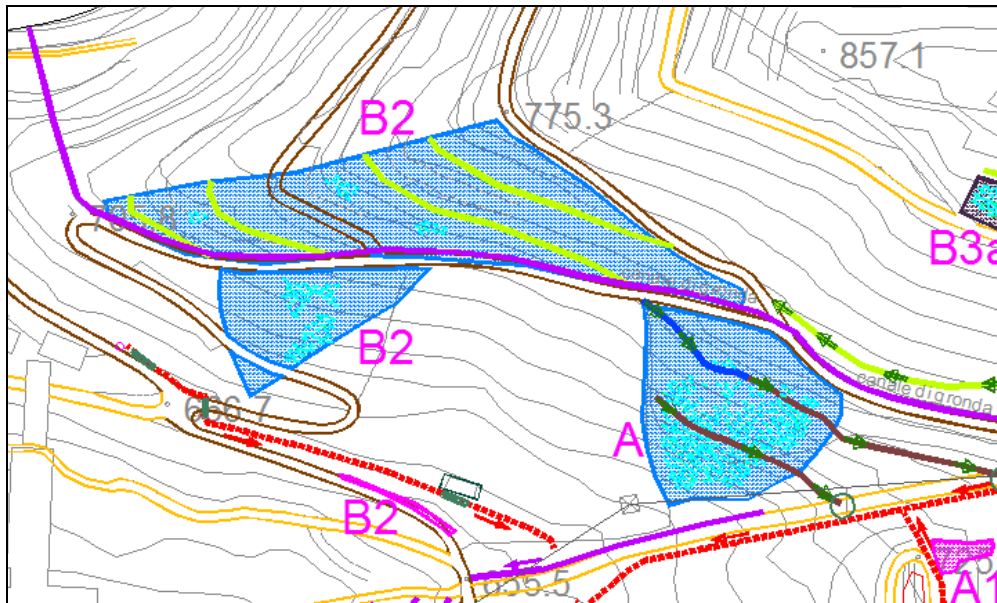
Unità progettuale B2 (cfr. elaborato C2 - Planimetria generale di progetto)
